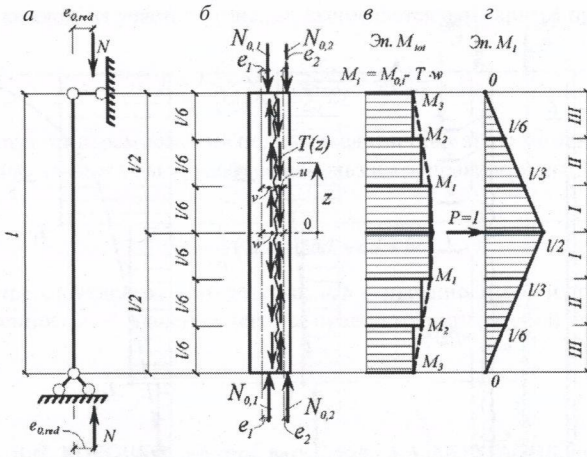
К расчету прогибов составных внецентренно сжатых железобетонных конструкций: а – расчетная схема, принятая в нормах; б, в, z – расчетная схема составного стержня, эпюра полного грузовой момента и эпюра единичного момента, соответственно
